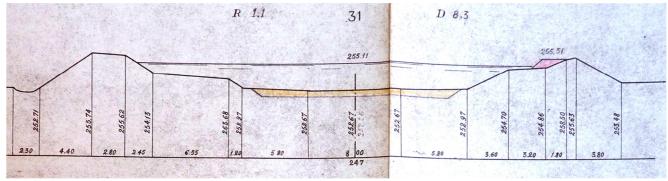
Profil en travers illustrant le curage et l'exhaussement des digues, 1940 (AD 73 – S 783)
